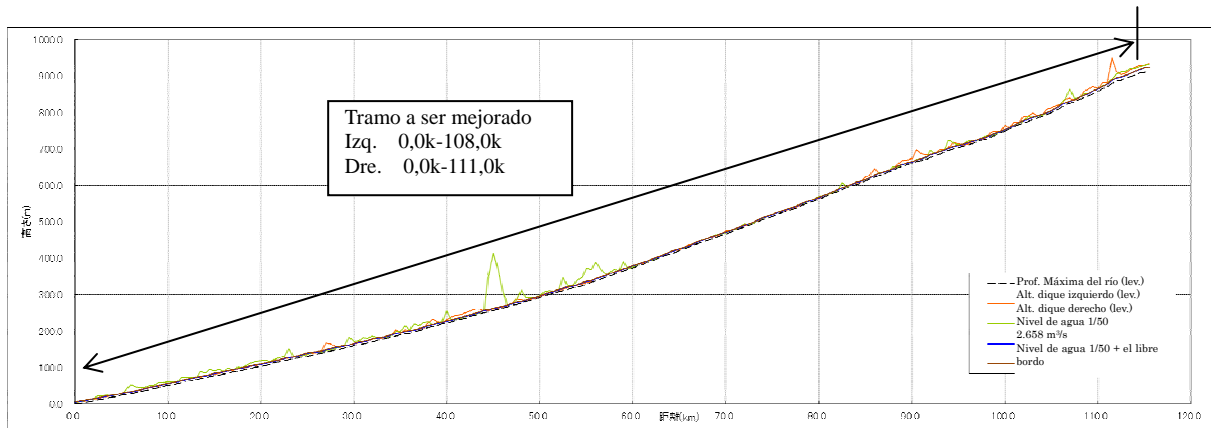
Perfil longitudinal del Río Majes-Camaná
